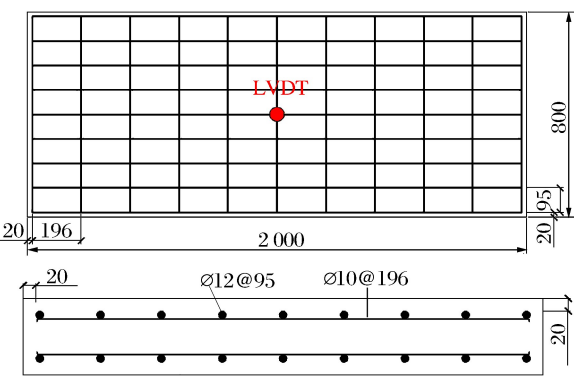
混凝土板尺寸及钢筋布置(单位为 mm)
